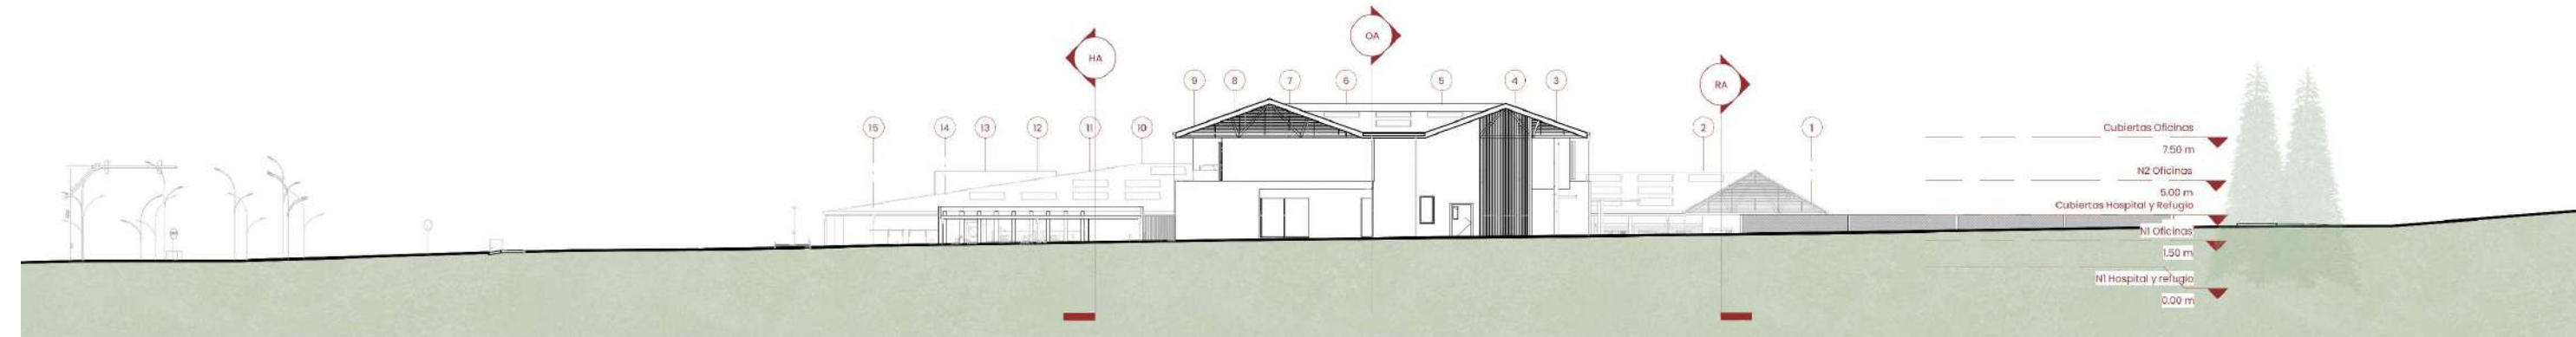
Fachada lateral (Este). Fuente: Elaboración propia
